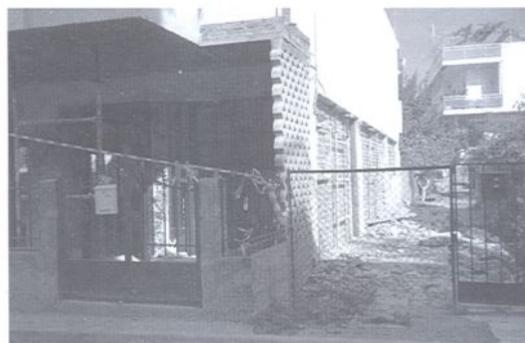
Полное отделение наружного слоя двурядной стены здания
